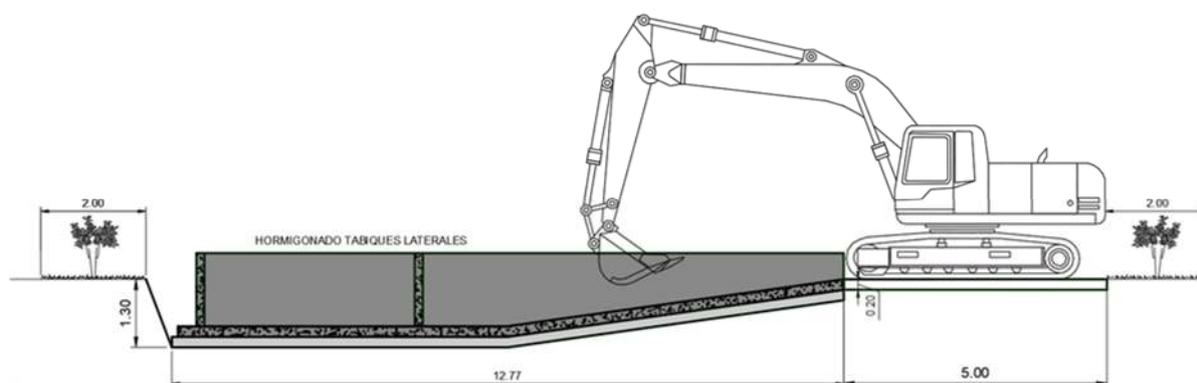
Sección hormigón de tabiques laterales. Hormigón tipo H30-CAH.
